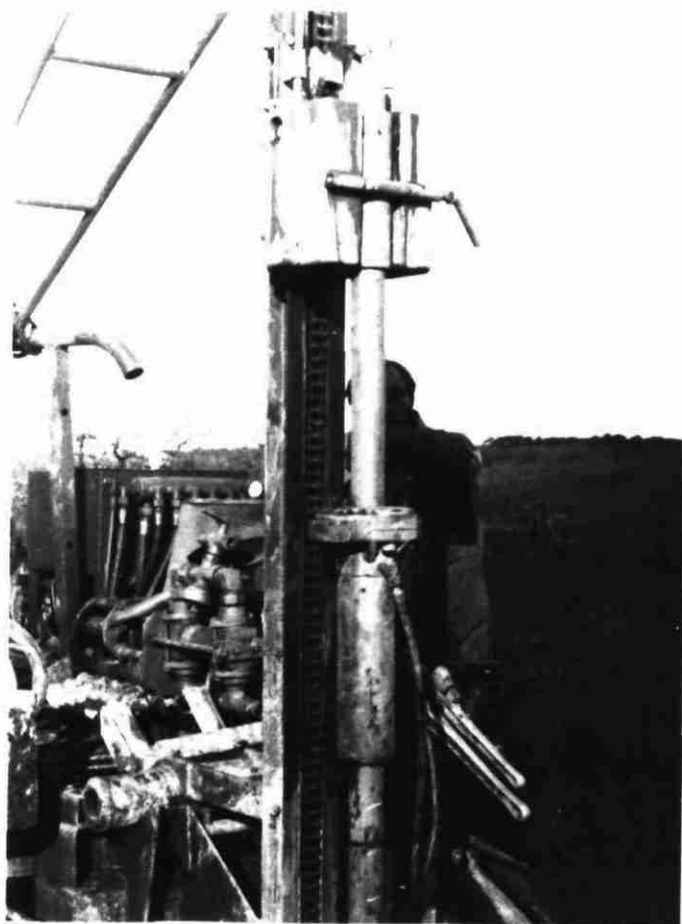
Enfoncement des tubes par battage à la sondeuse D 9000
